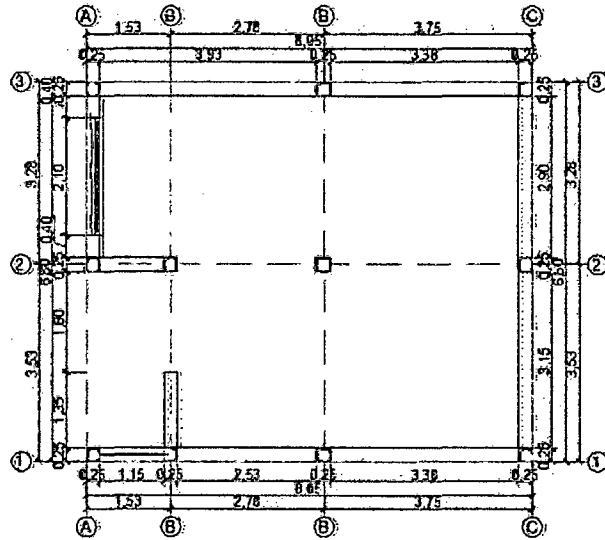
Plano de arquitectura de la planta típica de la Vivienda TV6.
